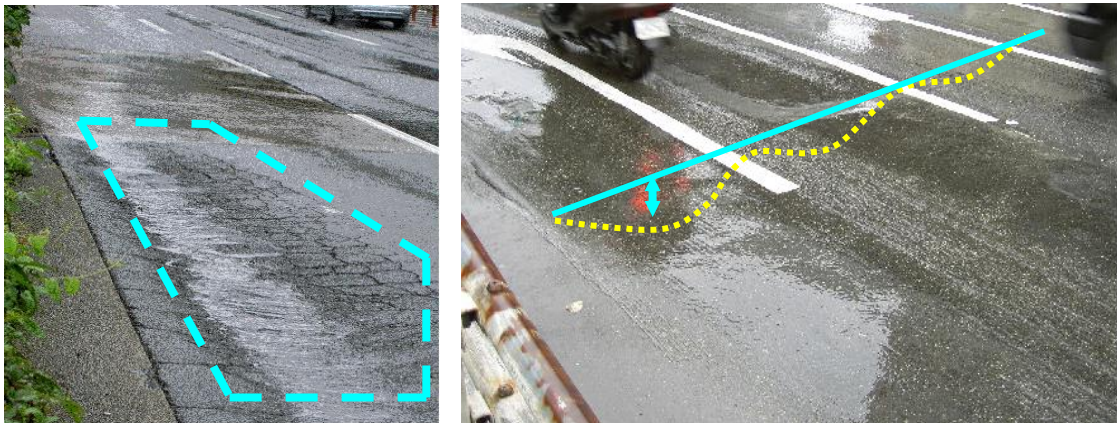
車道舗装の損傷（左：ひび割れ、右：わだち掘れ）
